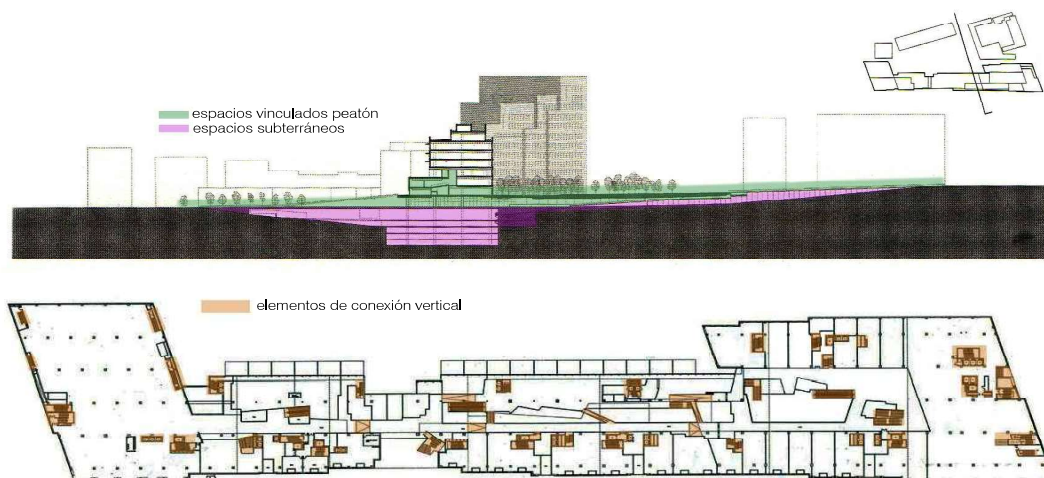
Sección transversal: Fuente (189) Figura 191: Planta primera:
